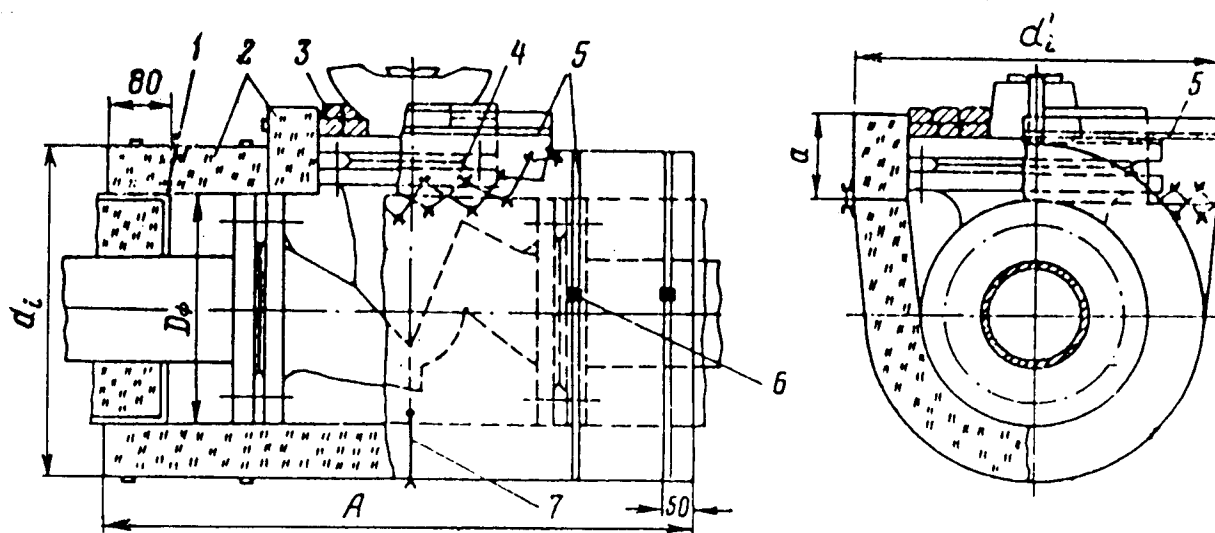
Ізолювання арматури теплоізоляційними матами: 1 – ізоляція трубопроводу; 2 – мата мінераловатна; 3 – джгут або шнур теплоізоляційний; 4 – зшивання; 5 – бандаж; 6 – пряжка; 7 – підвіска
